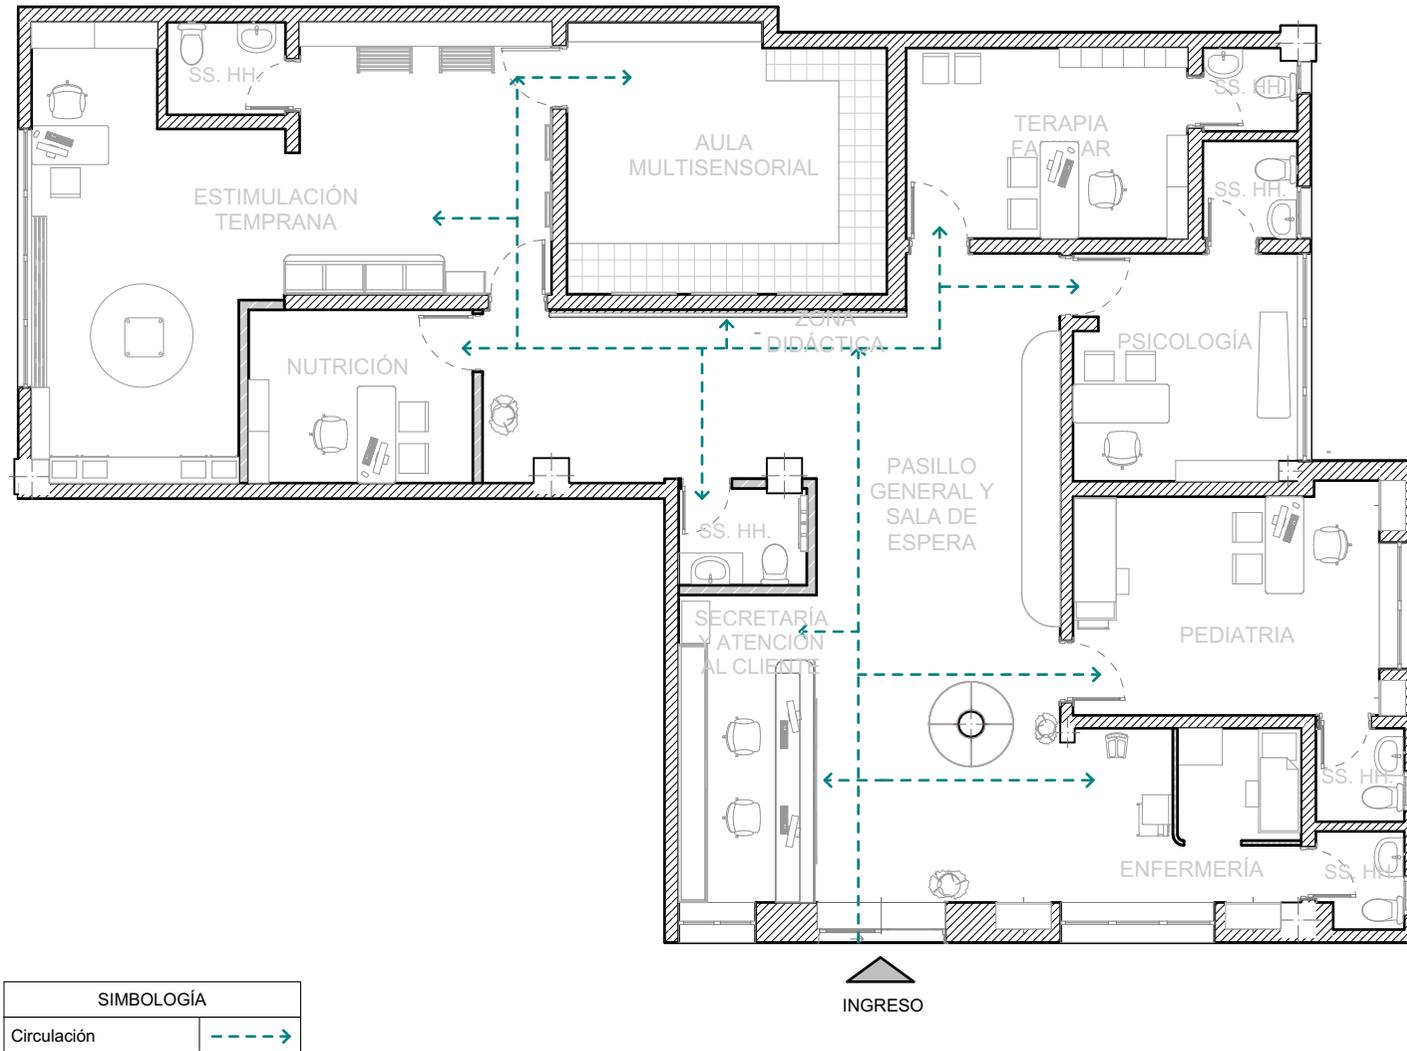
Planta de circulación CEDIUC Fuente: Propia
